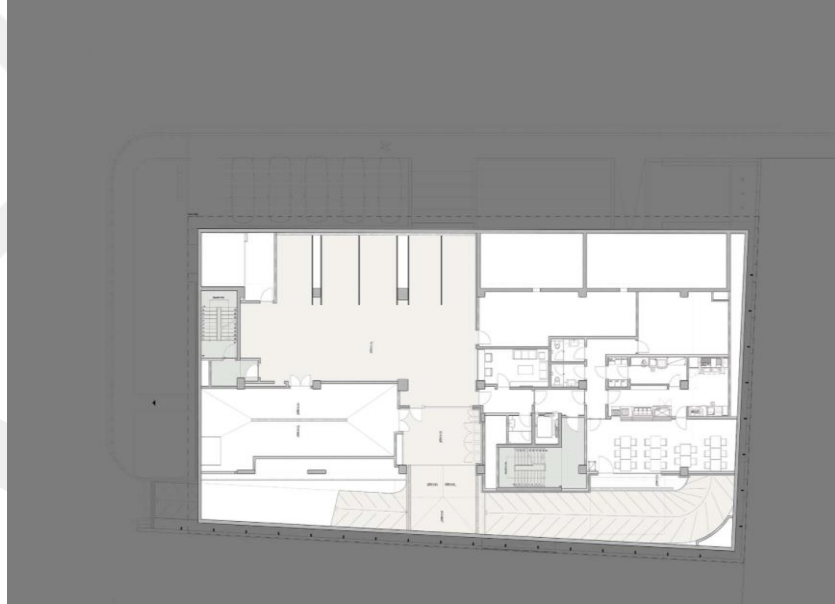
Türkiye Mütcahhitler Birliđi Binası Vaziyet Planı (ARKİV 2022)
